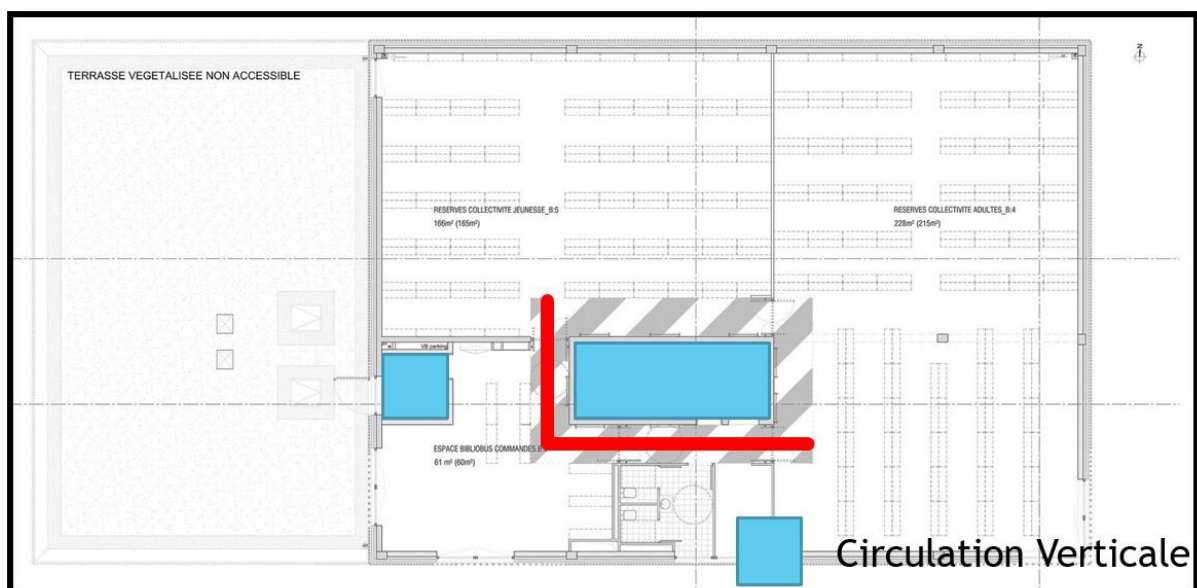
Plan du 1er Etage (Source : Archdaily.com)
